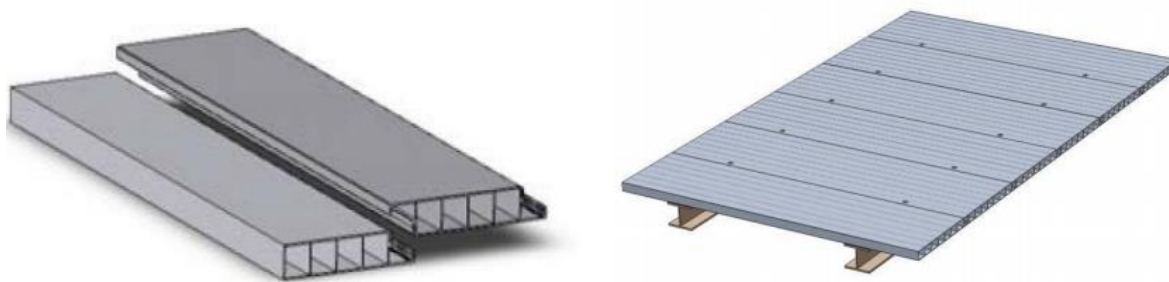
Esquema de montagem do tabuleiro por meio da ligação sucessiva entre painéis (Martinho, 2013).
